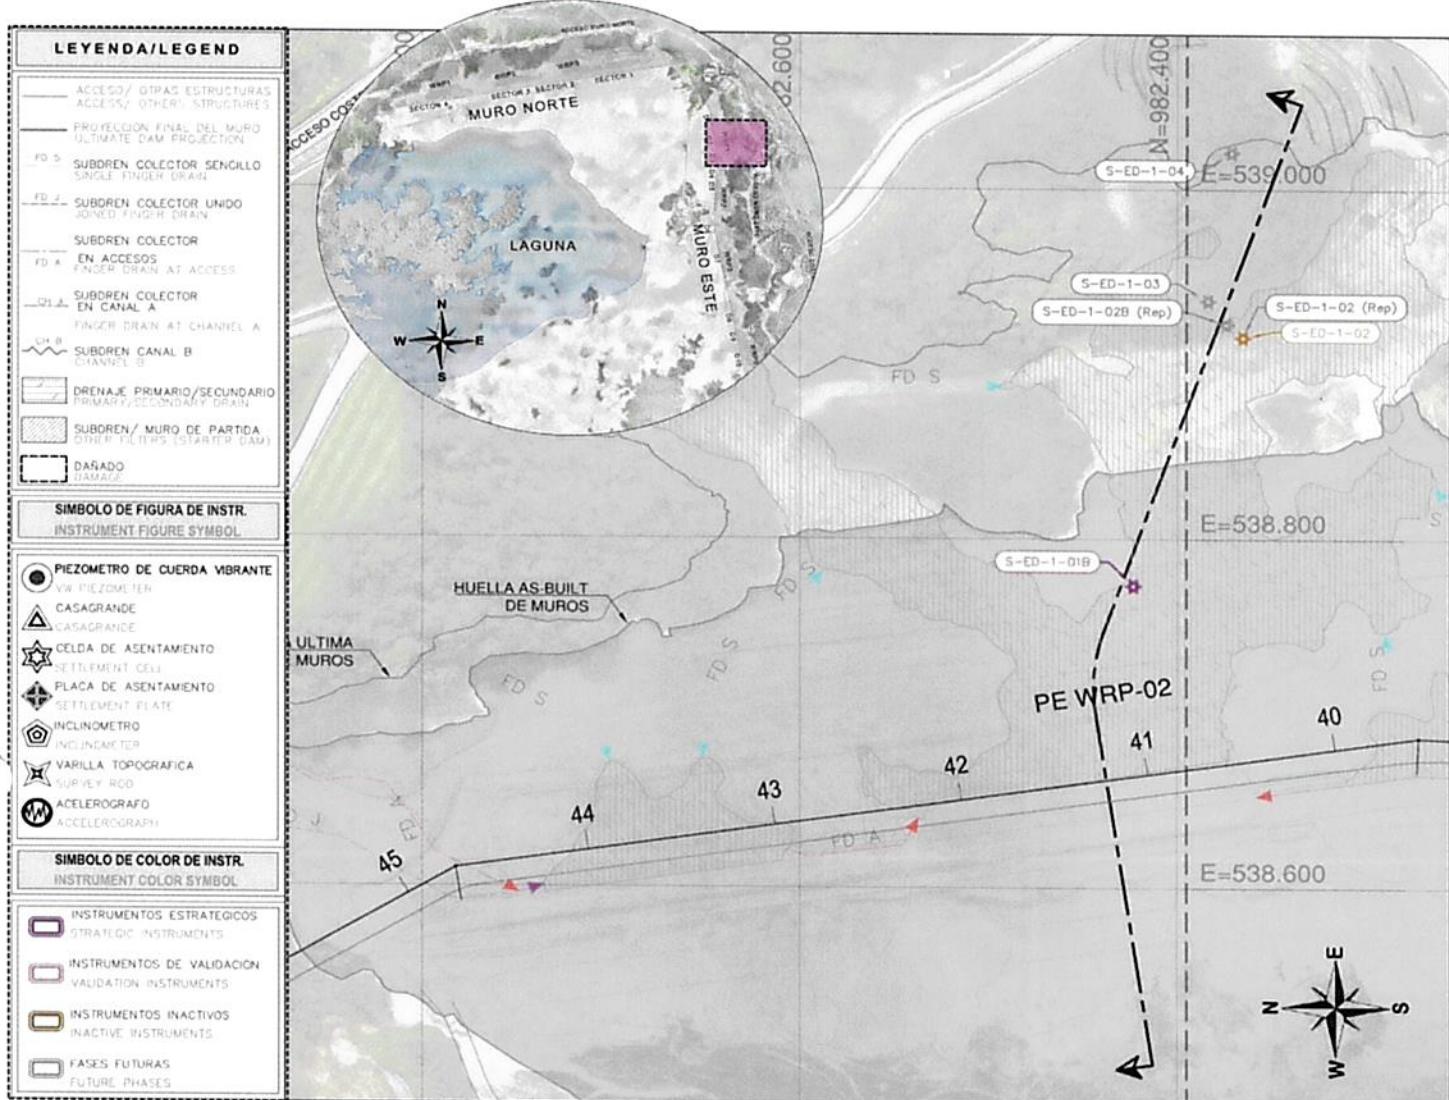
Vista de Planta en el Muro Este WRP1 con las Celdas de Asentamiento
